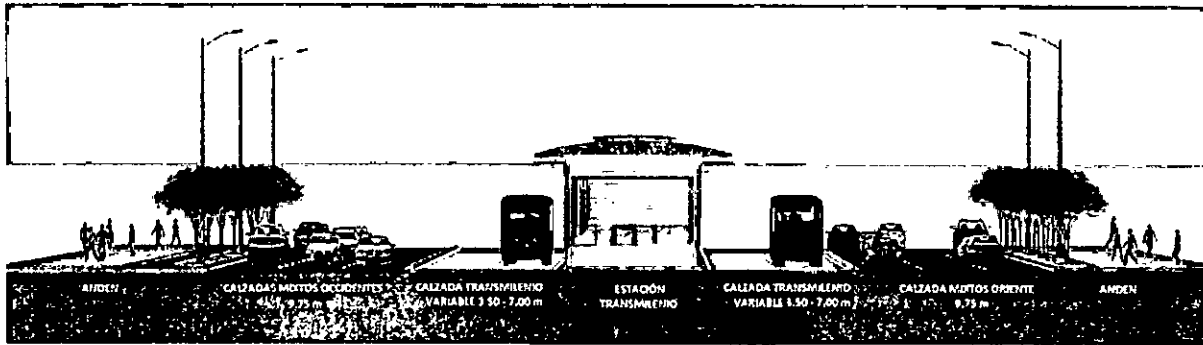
Sección transversal típica en estación tramo 4 desde la Calle 22 hasta la Calle 26 y desde la Calle 68 hasta la Calle 127.
